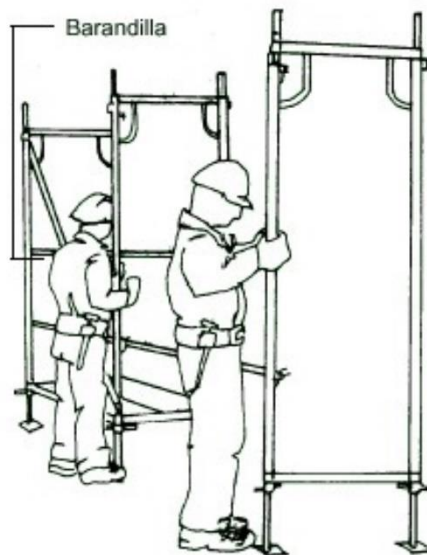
Colocación de las barandillas y el encadenamiento del andamio
